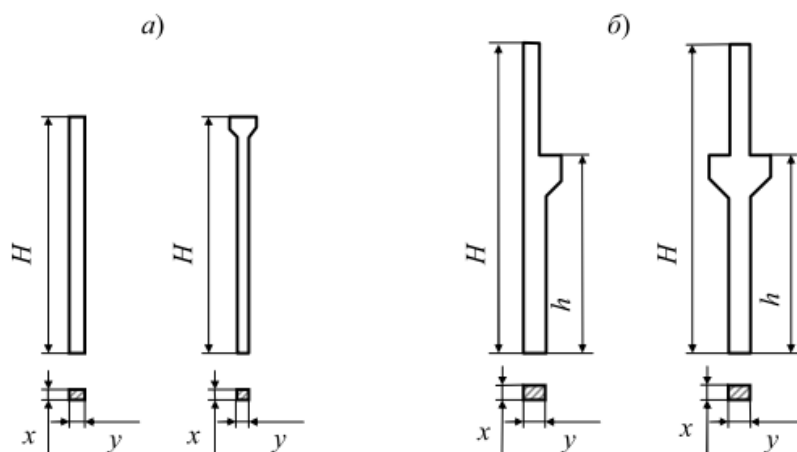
Колонны: *а* – для бескрановых зданий; *б* – для крановых зданий;
